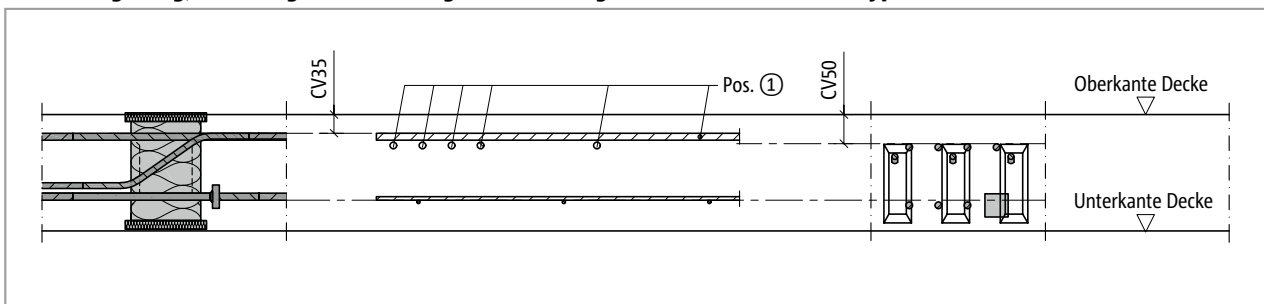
Schöck Isokorb® XT Typ C: Bauseitige Bewehrung Außenecke (Schnitt XT Typ C-L-CV35, Ansicht XT Typ C-R-CV50)
